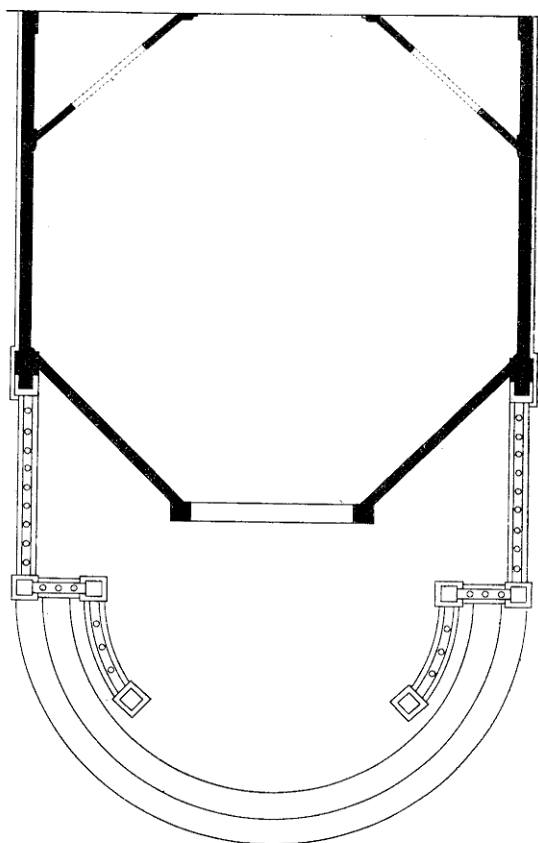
Plan du Pavillon d'honneur de la Mécanique française.
